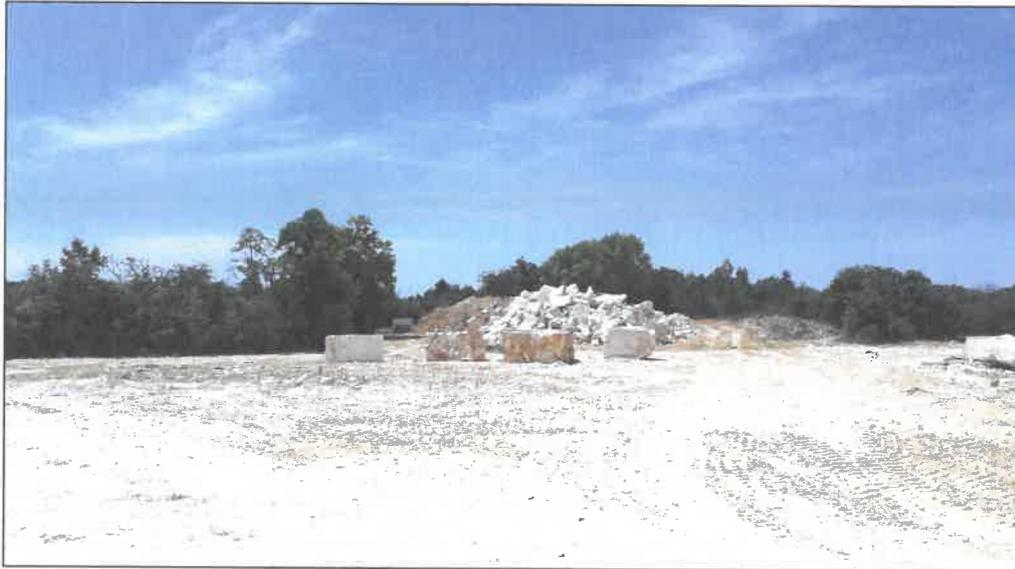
Vue sur le secteur Ouest en cours de remblaiement
